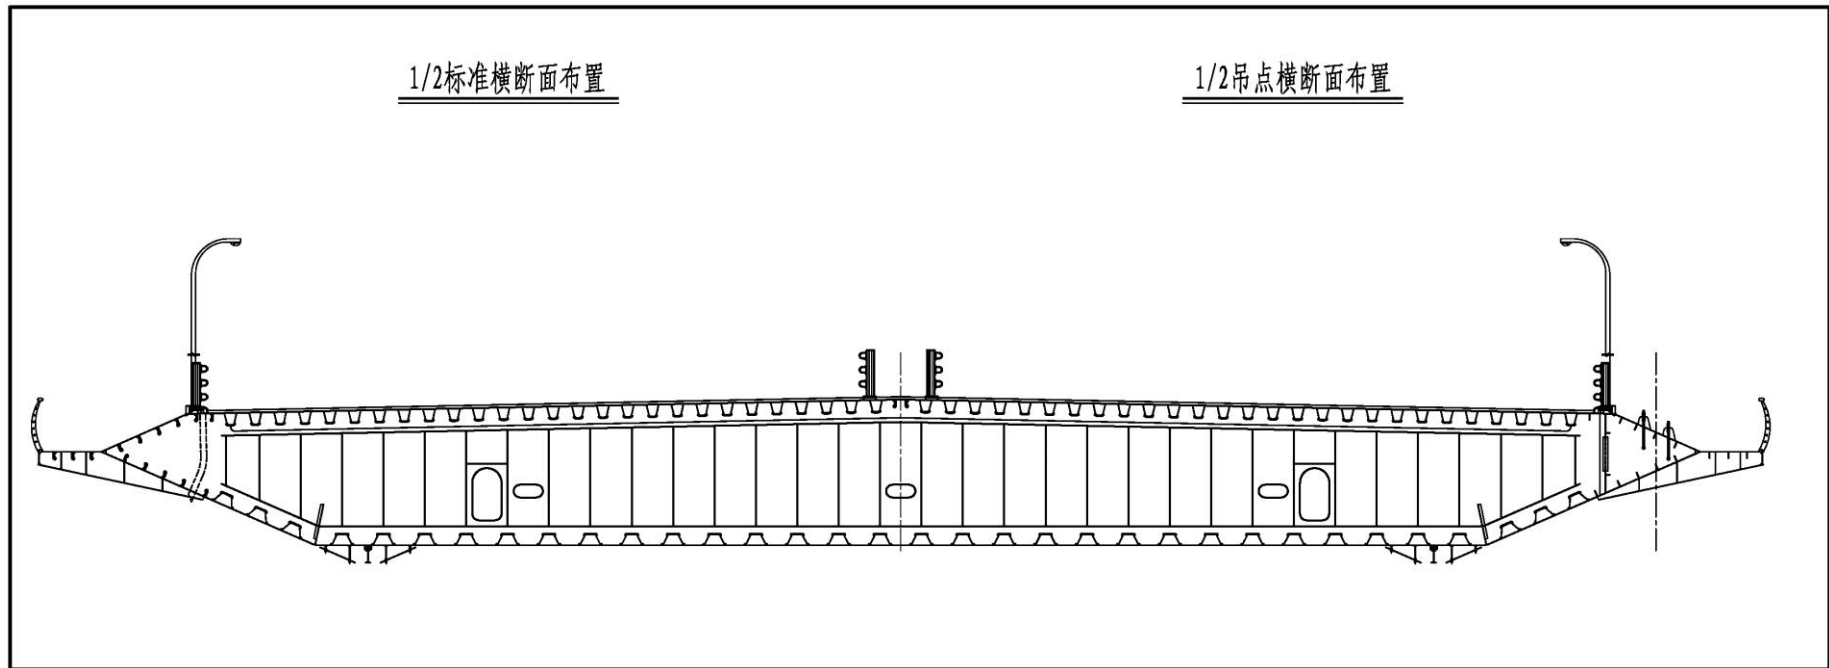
南汉桥主跨钢箱梁标准断面图
